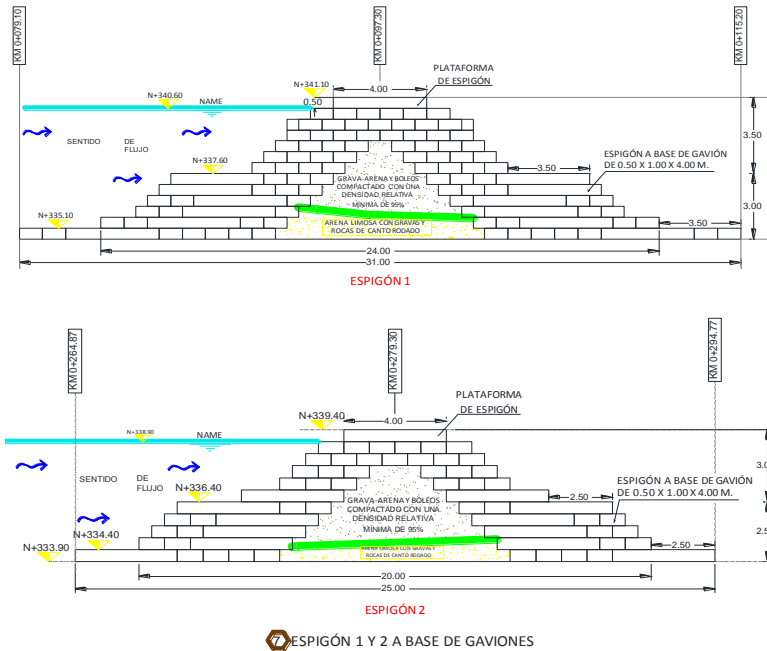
Corte transversal del espigón número 1 y 2 donde se aprecian los niveles del espigón y el corazón de material grava-arena.
